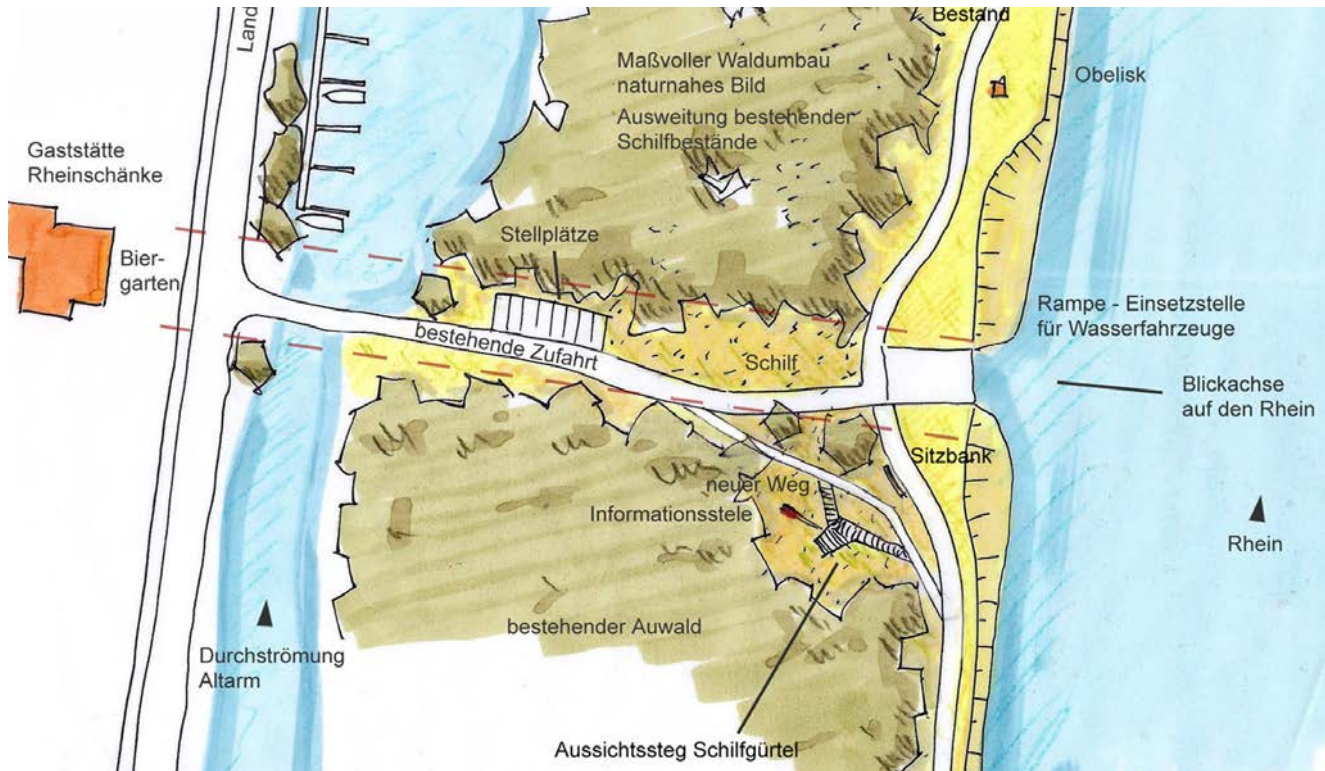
Lageplan Umgestaltung Achse Rheinschänke – Jetskianleger mit Informationspfad, M 1:1.000
